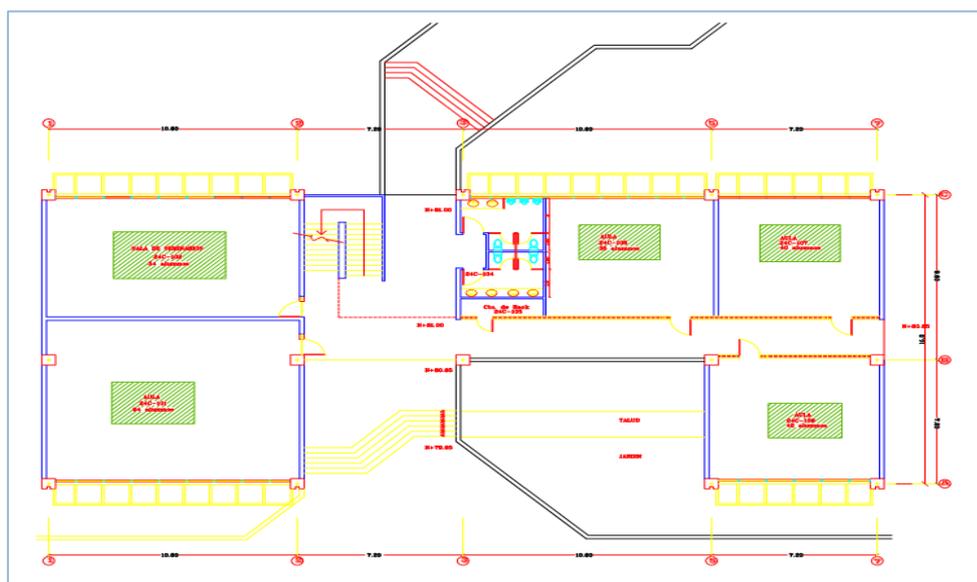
Planos Bloque C Planta Baja – Zona 1
